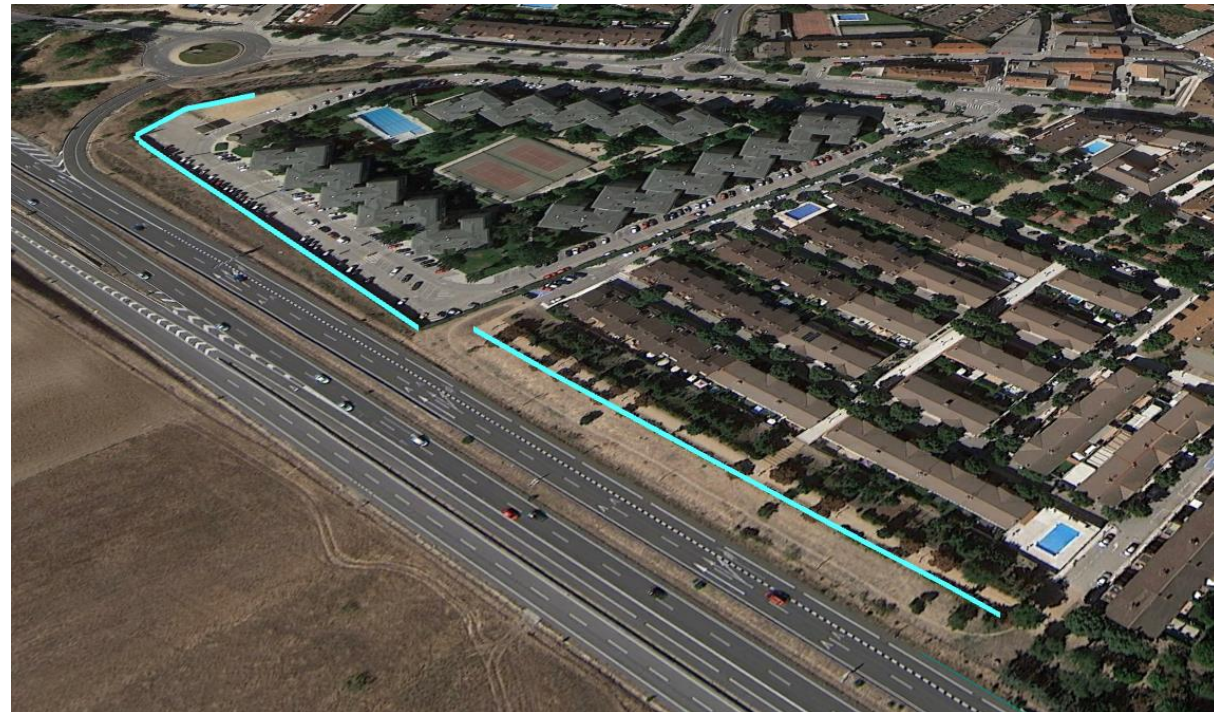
Localización en planta pantallas PT-16 y PT-17. Ortofoto
